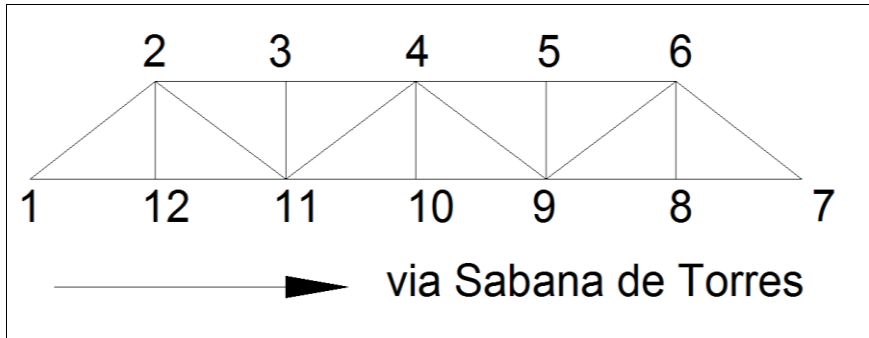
Denominación nodos de la armadura, Puente 1. Fuente (Autores).
